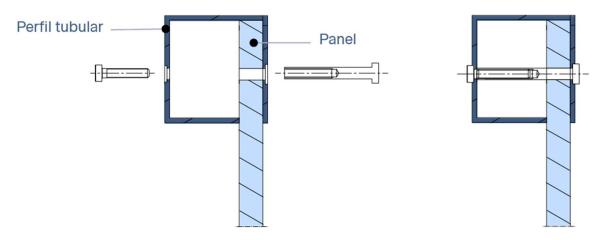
Croquis detalle montaje paneles con tornillo de conexión
